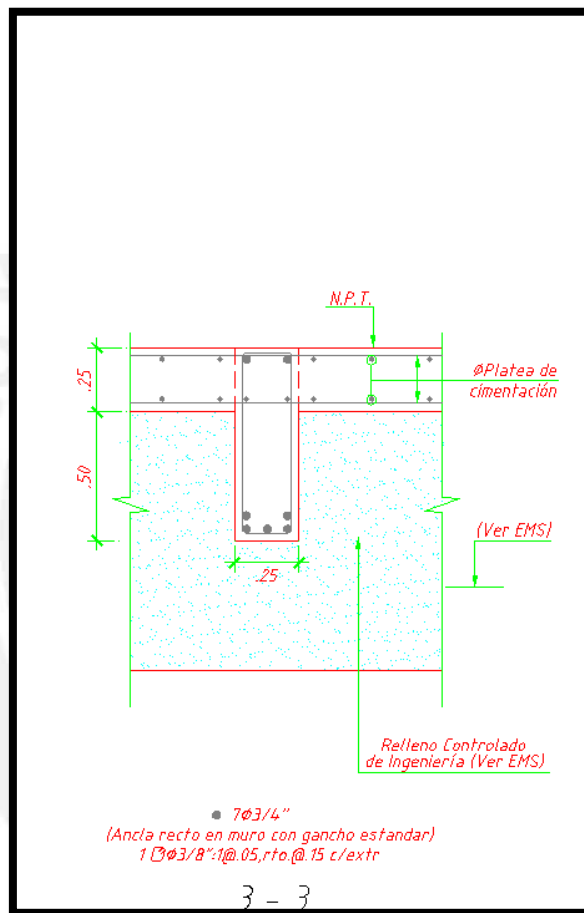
CORTE DE VIGA DE CIMENTACIÓN (3-3)
